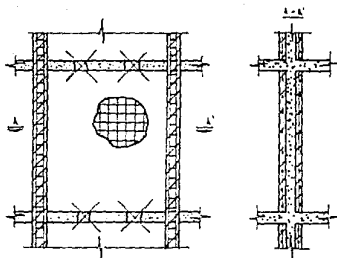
Continuidad de refuerzo en muros de concreto.
